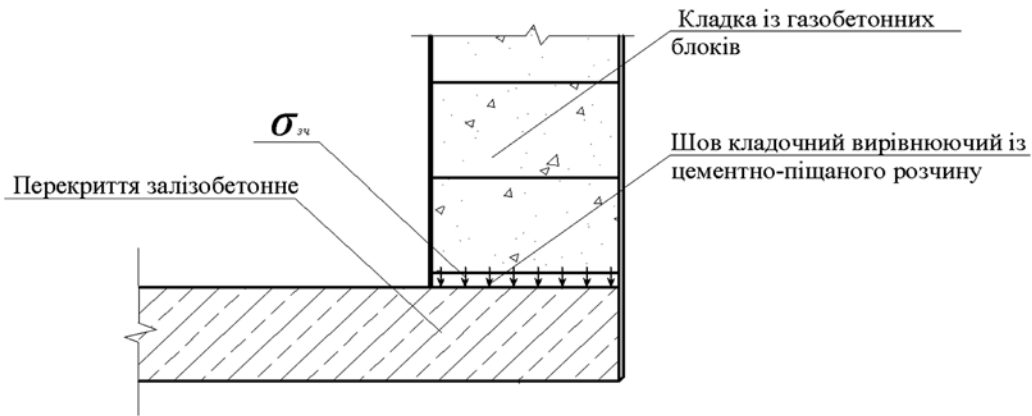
Схема зчеплення першого ряду кладки з монолітним перекриттям
